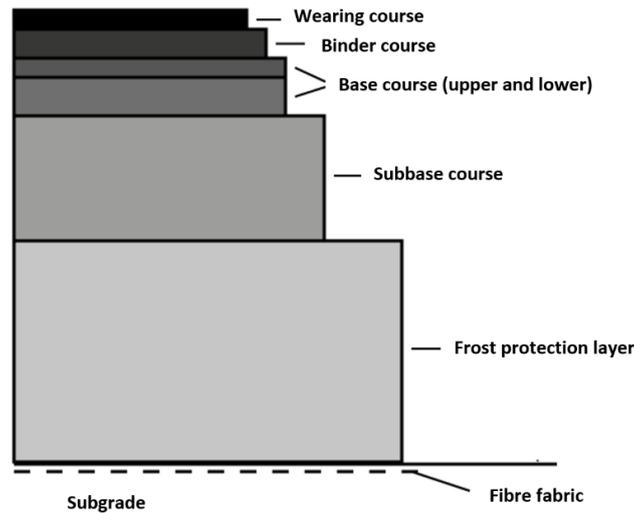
Construction d'une route norvégienne typique avec couche de protection contre le gel (route à fort trafic, couche de fondation de mauvaise qualité).
